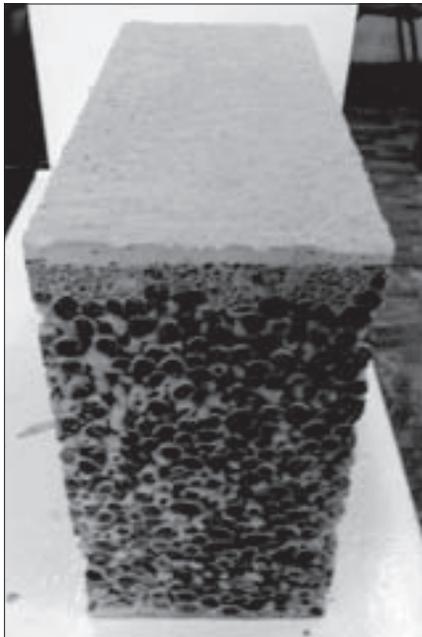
Фрагмент стенового блока из беспесчаного керамзитобетона
